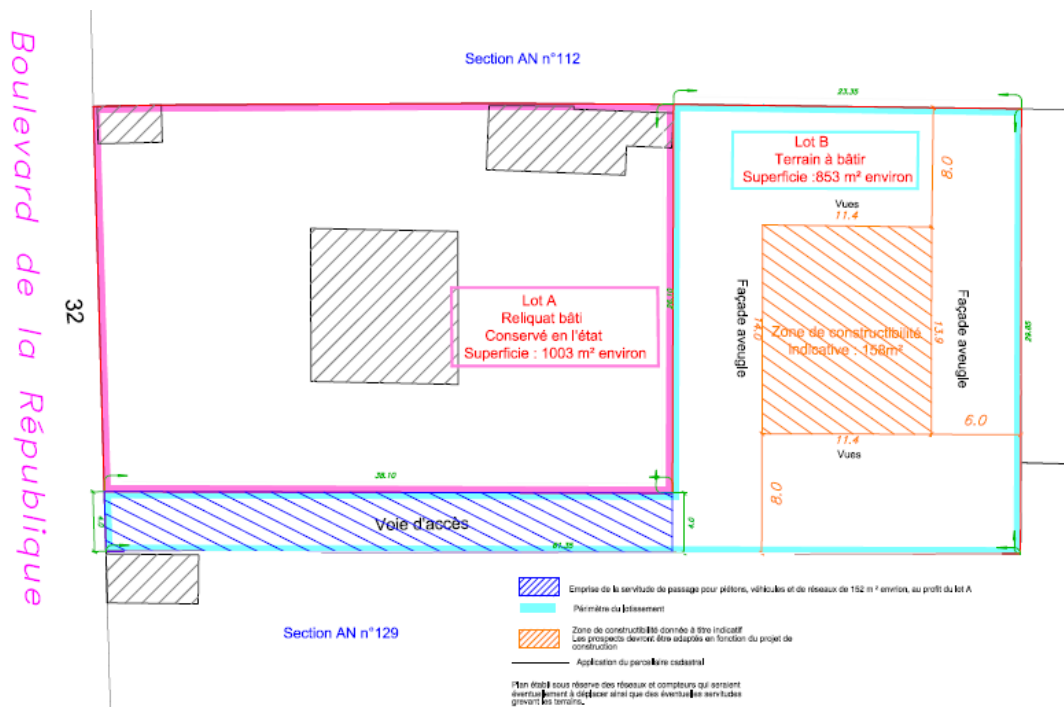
Plan projet avec la zone de constructibilité maximale
